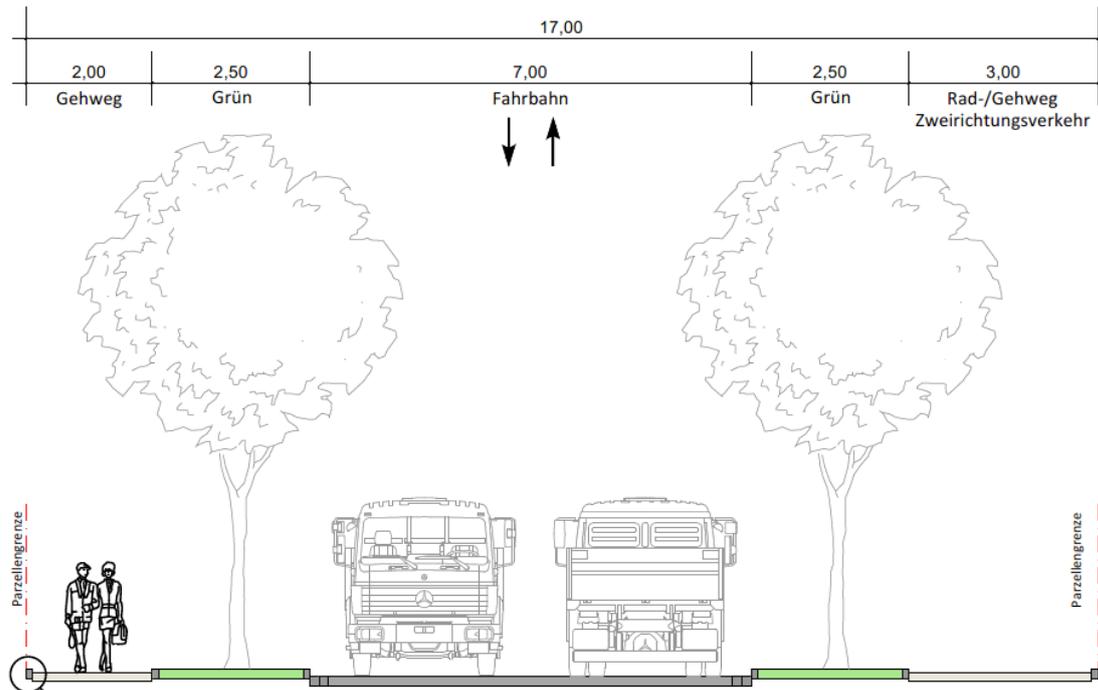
Systemschnitt Haupterschließungsstraße Bebauungsplan Nr. 366
